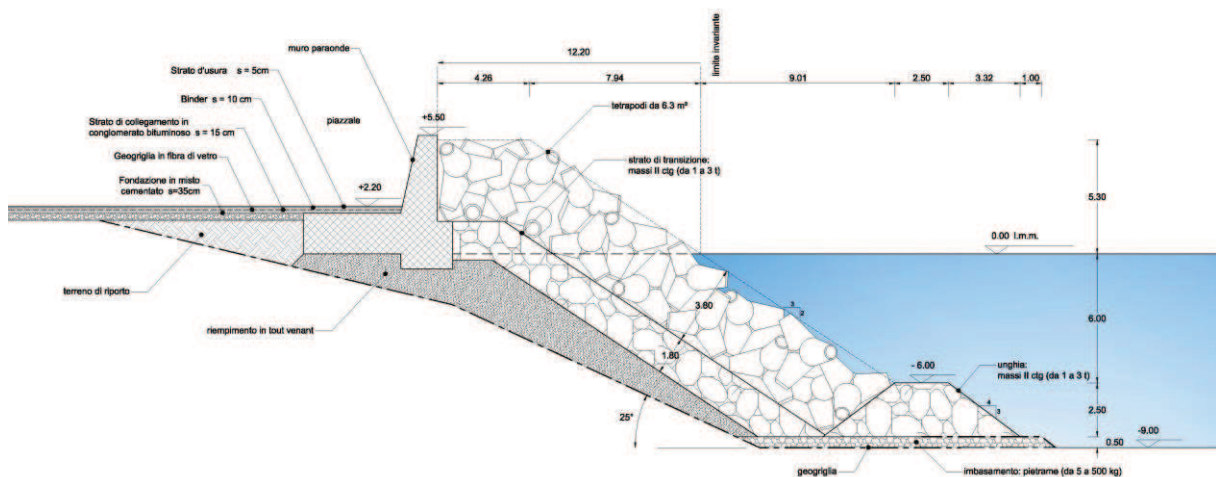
Sezione tipo scogliera lato nord (PROGETTO SIGENCO).
